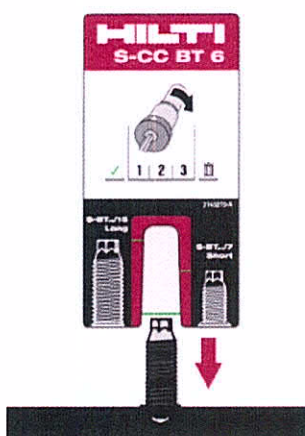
Проверка глубины вкручивания шпильки калибровочным шаблоном Hilti S-CC BT6
